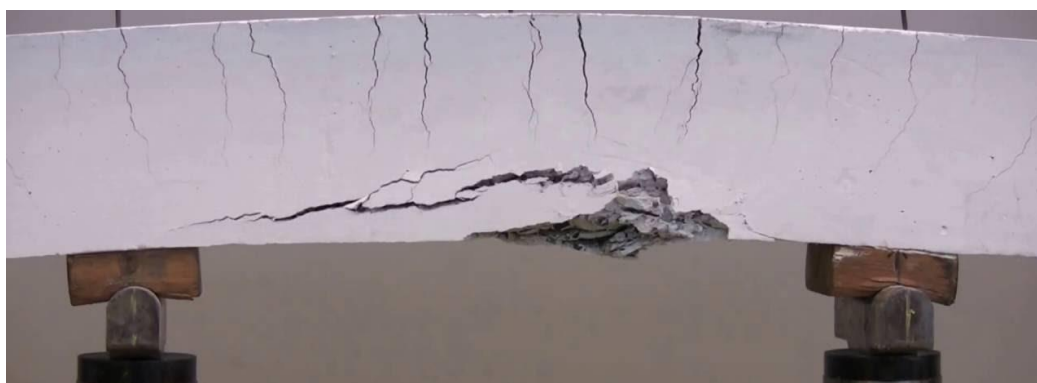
Exemplo de fissuração em viga de betão armado após ensaio de carga. (Andersen, 2016)
